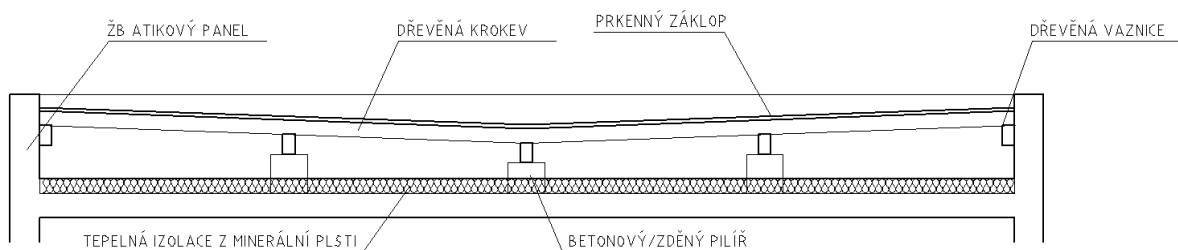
Schéma příčného řezu- Varianta s dřevěným horním pláštěm
